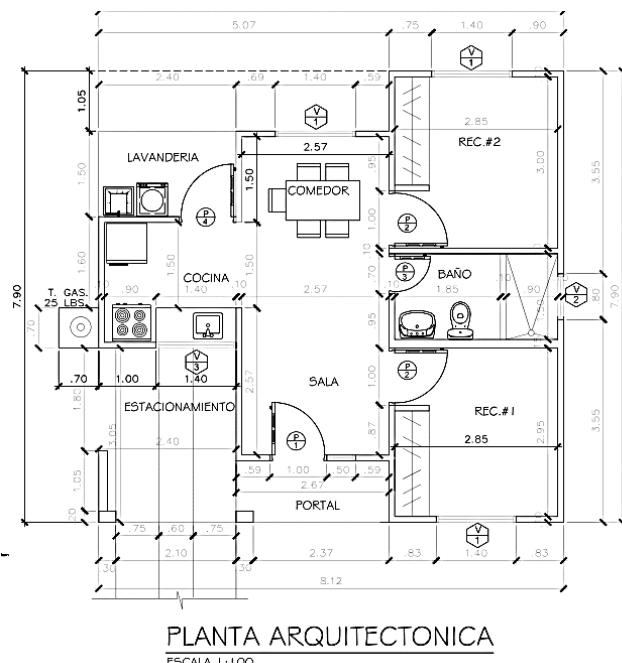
Planta arquitectónica de vivienda Modelo Judith
